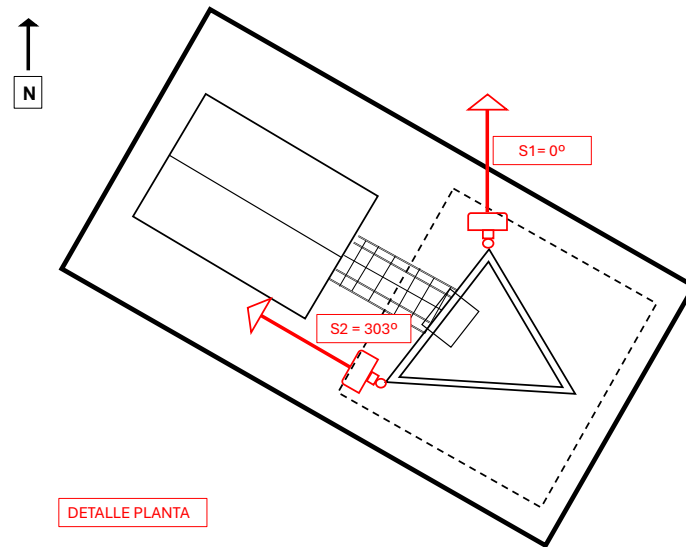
Detalle planta del emplazamiento con sector de las antenas. [elaboración propia]
